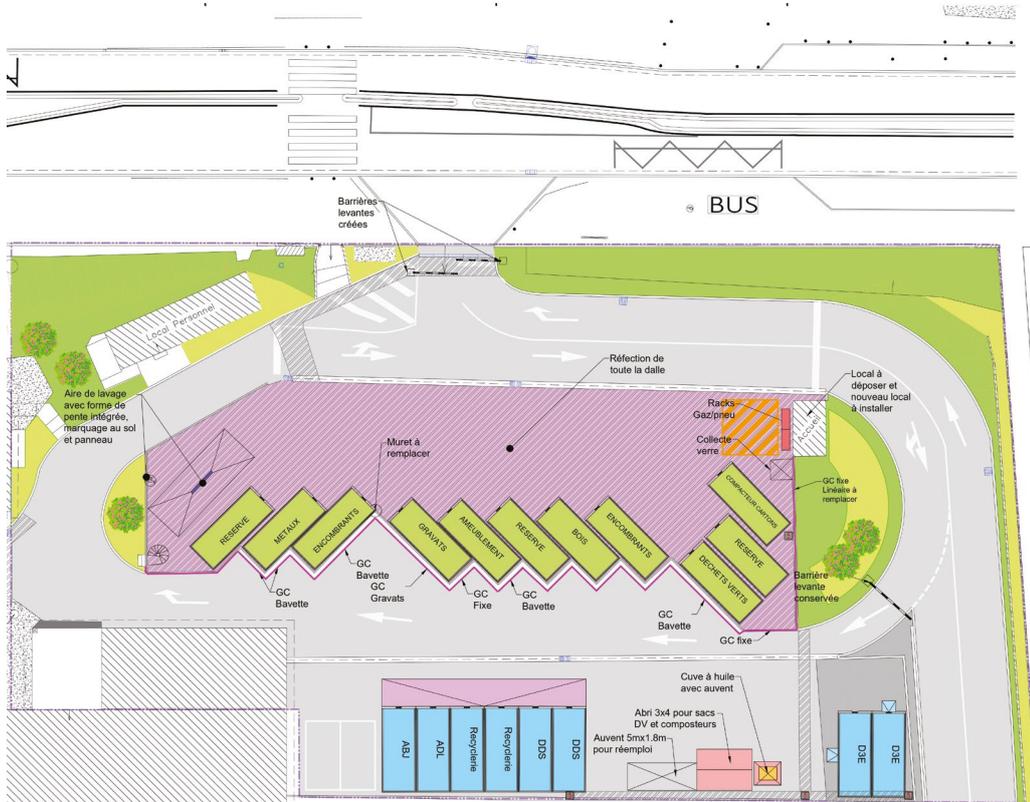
Plan des travaux de la déchèterie des Pavillons-sous-Bois
